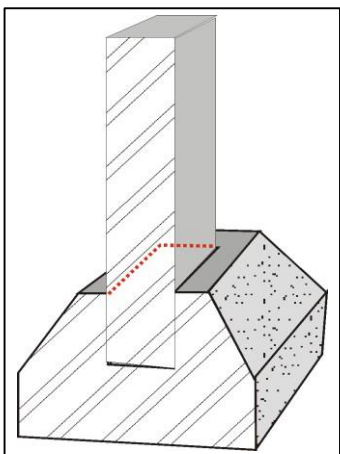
Detalhe da inserção do pilar no elemento de fundação
